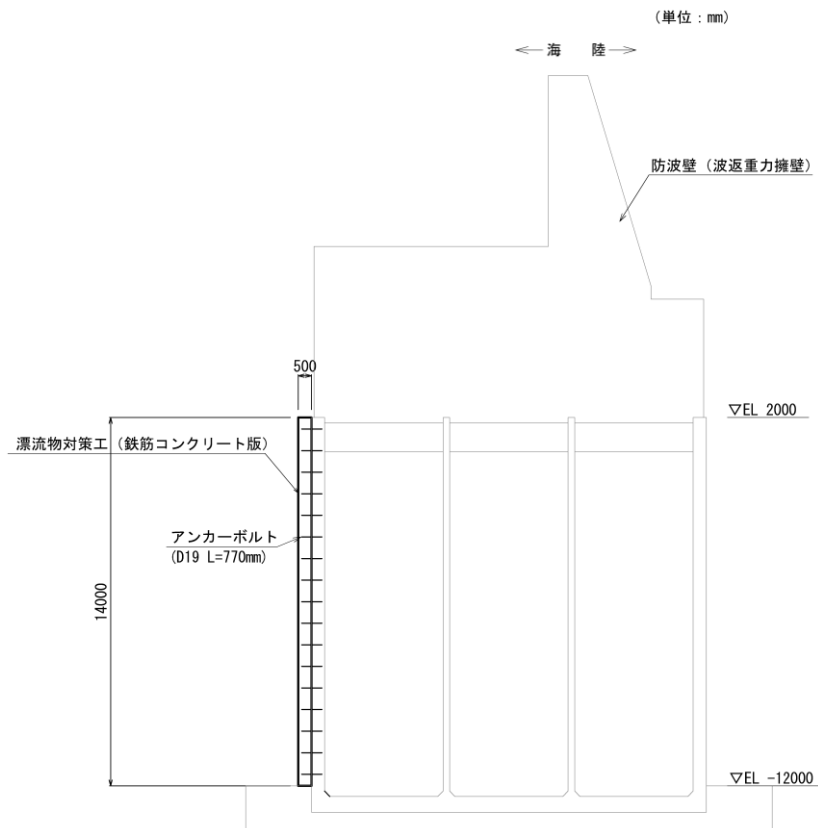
(4) 防波壁 (波返重力擁壁) ケーソンにおける漂流物対策工 (鉄筋コンクリート版) のアンカーボルト配置図 (断面図)
